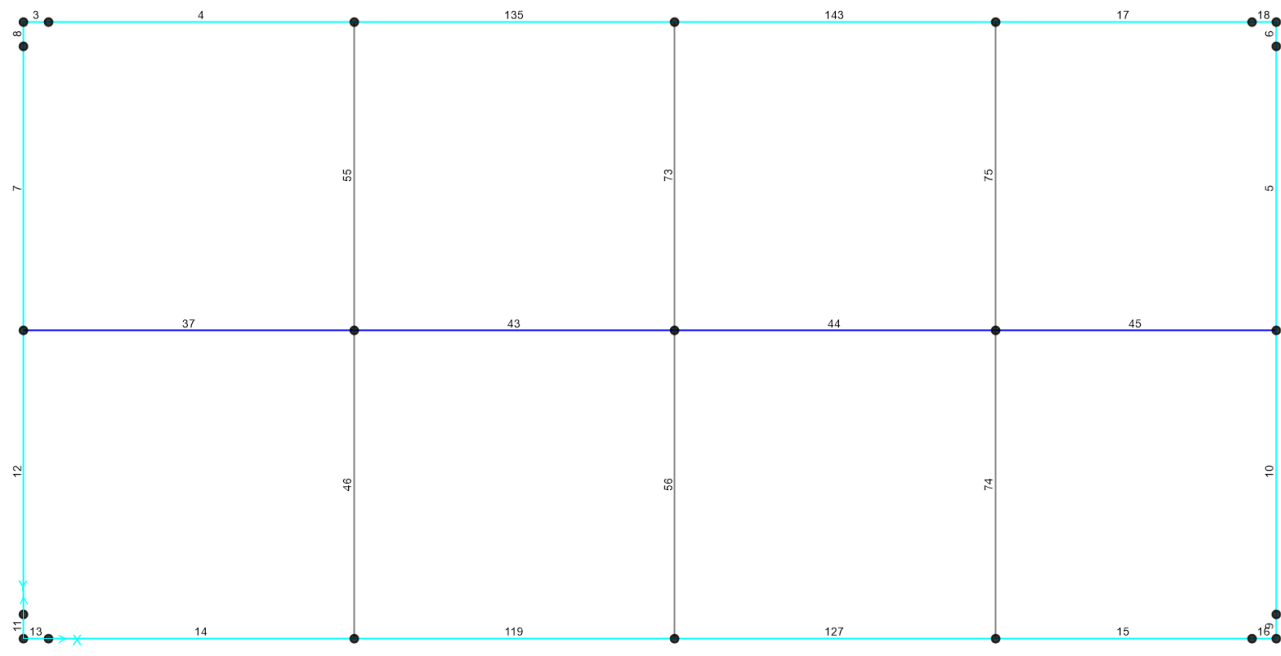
Pianta del modello di analisi delle travi di fondazione – numerazione elementi frame
